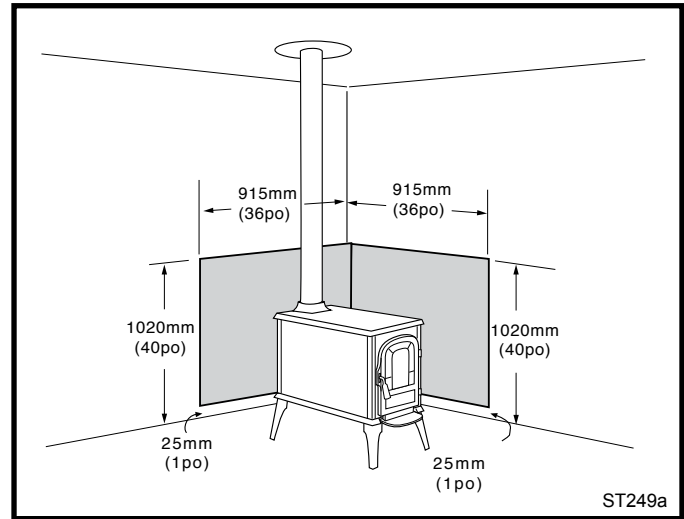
Installation parallèle avec conduit de raccordement vertical et double écran mural pare-chaueur.
